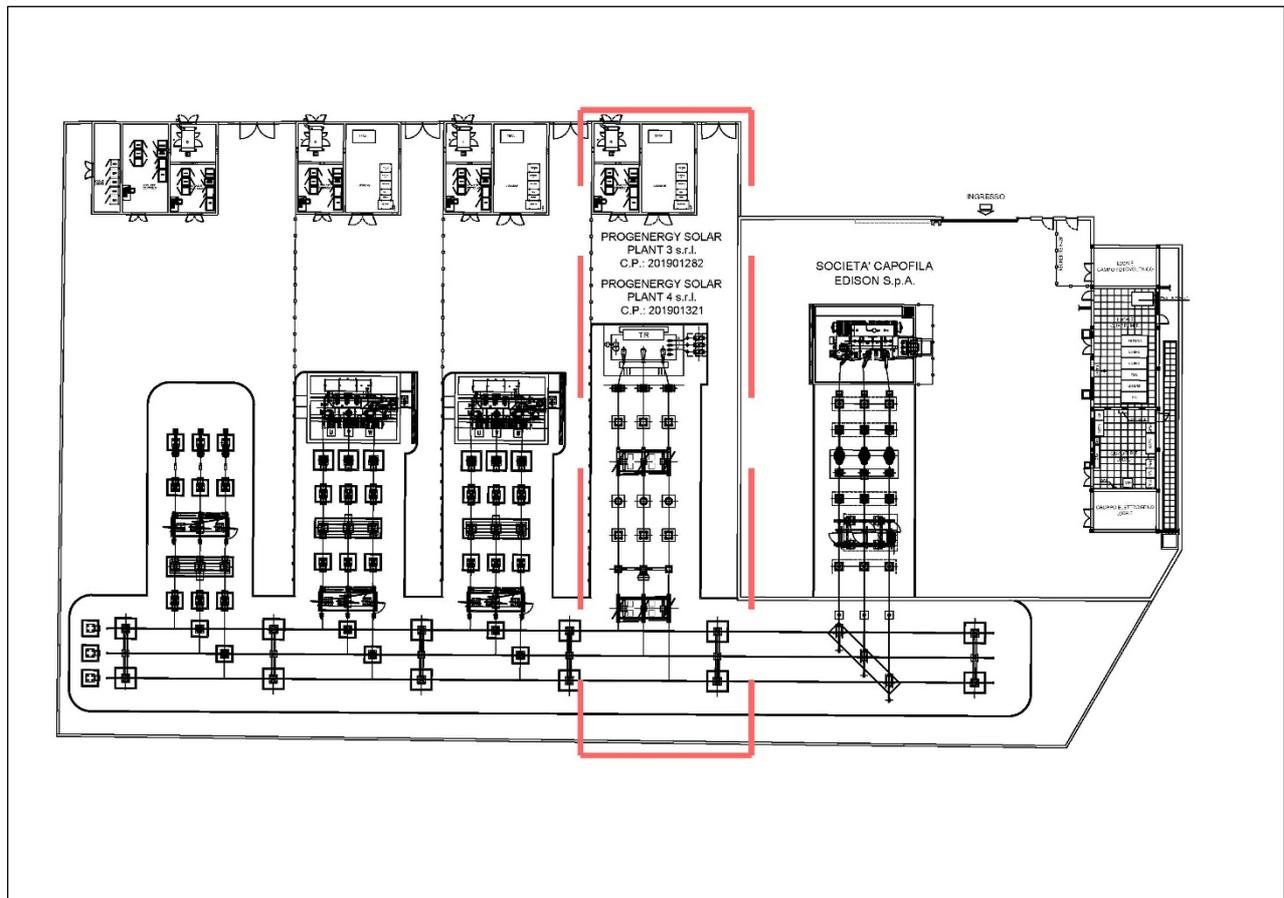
Planimetria della SE condivisa con individuazione della area produttore.
